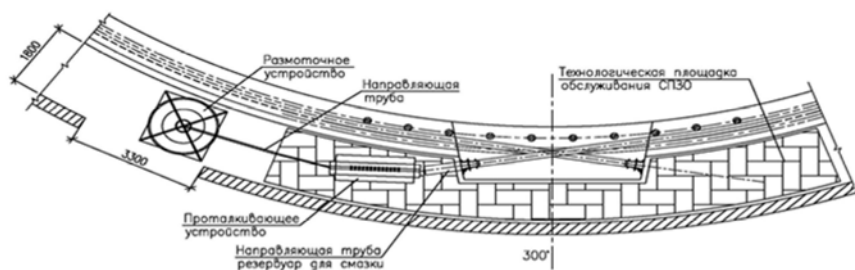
Монтаж арматурных пучков методом проталкивания
